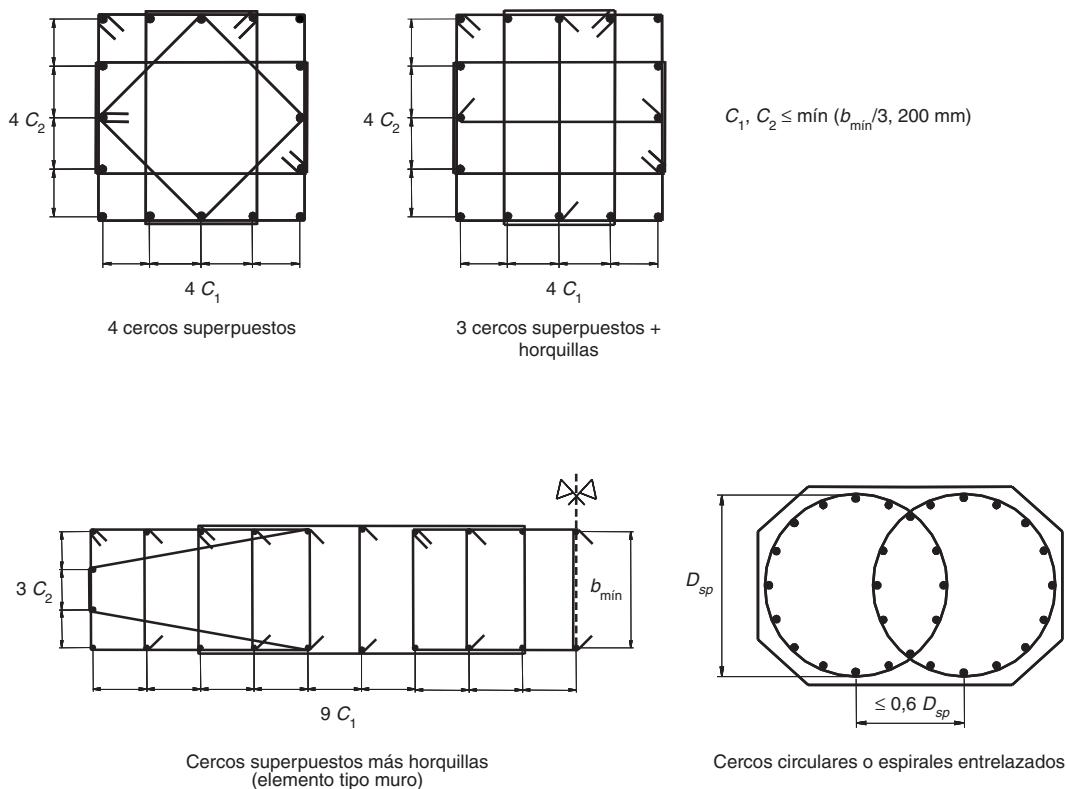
Disposiciones geométricas relativas a las armaduras transversales de confinamiento en zonas de rótulas plásticas
